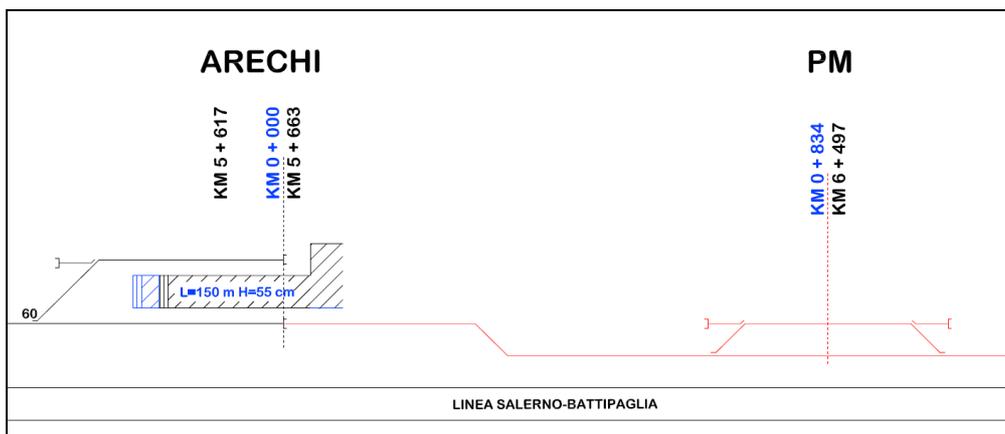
Schema funzionale di progetto – Fermata M8 Arechi e nuovo PM
